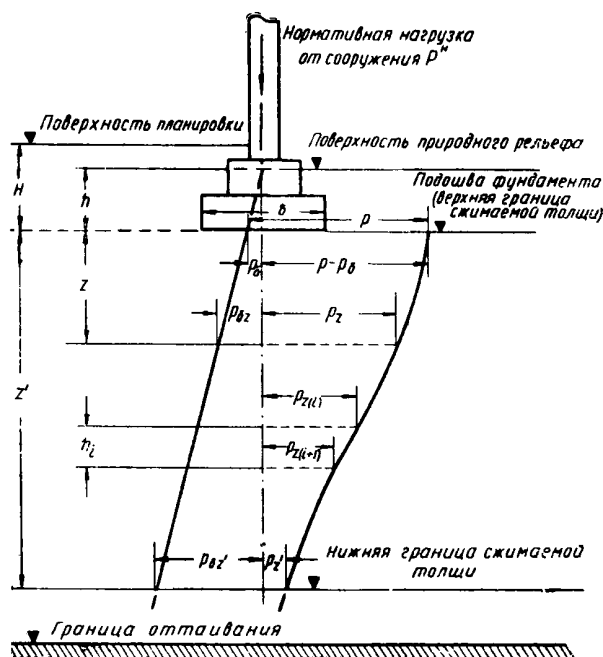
(2). Расчетная схема распределения давления на горизонтальных сечениях в грунте ниже подошвы фундамента
